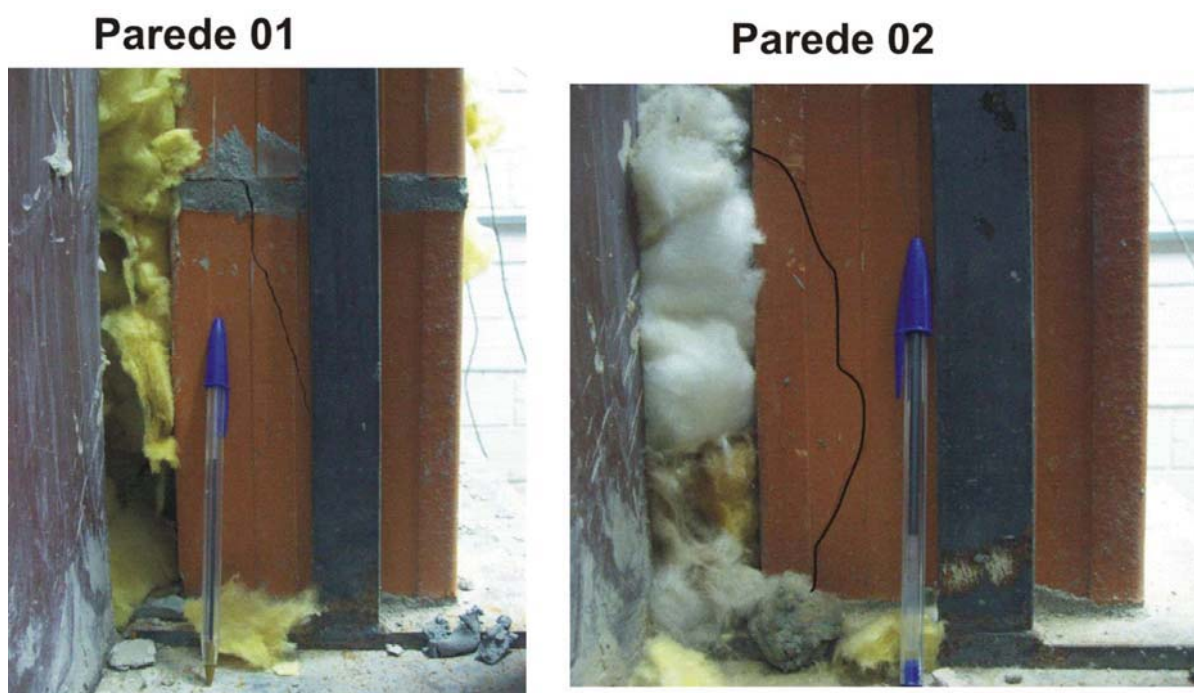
Detalhe de fissuras transversais nas laterais das paredes 01 e 02.
